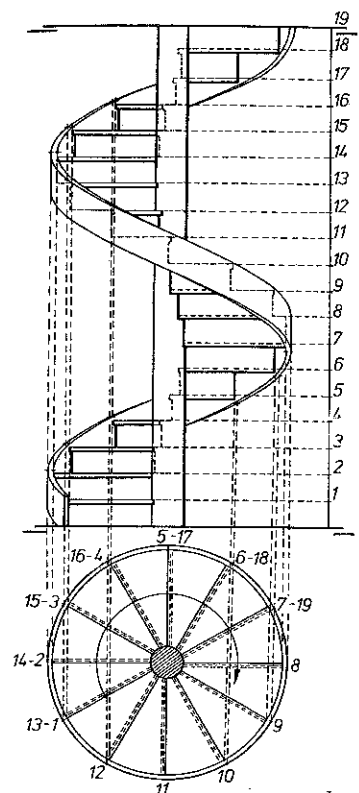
Alzado y planta de una escalera de caracol o de hélice.
